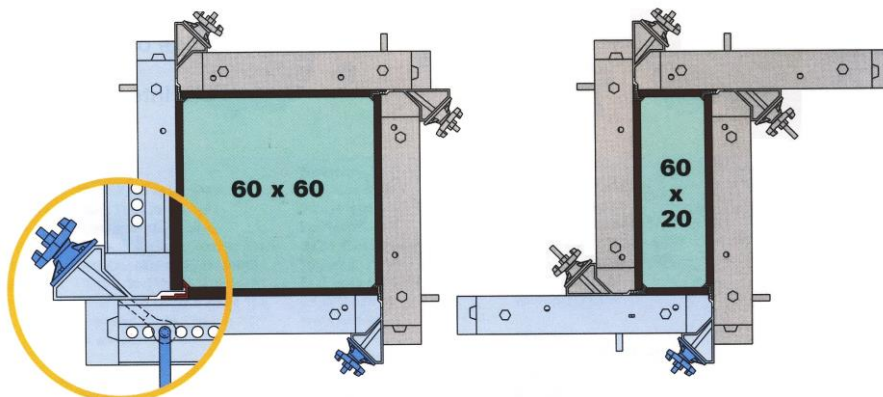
Detaliul elementului de îmbinare în plan al panourilor „Rapid”
